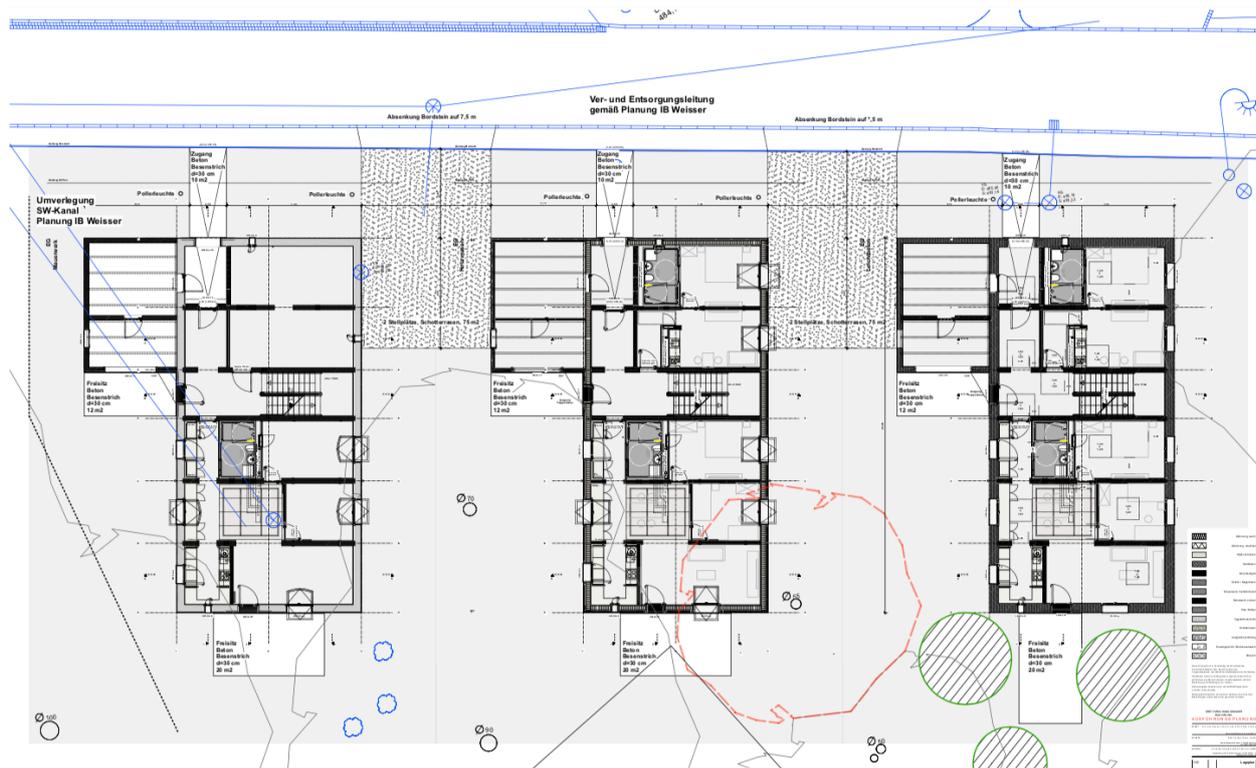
Lageplan Drei Forschungshäuser Bad Aibling: Gebäudearten Mauerwerk, Massivholz, Leichtbeton (von links nach rechts), Quelle Florian Nagler Architekten GmbH
